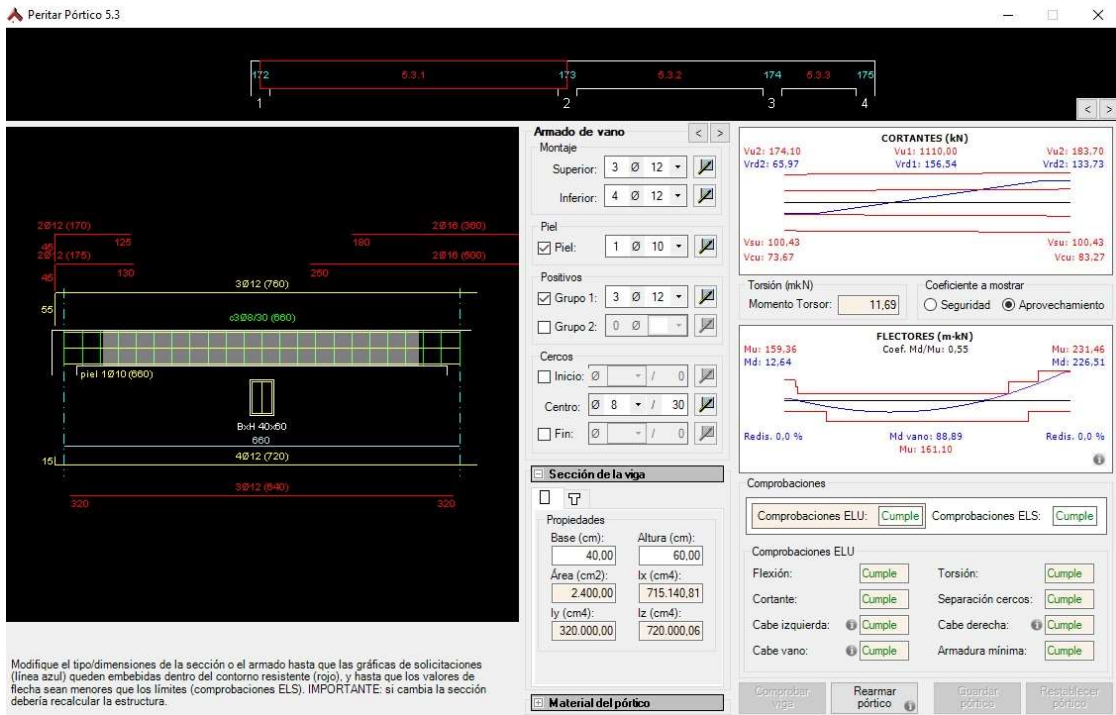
Peritación de la viga 5.3.2 de la estructura proyectada
